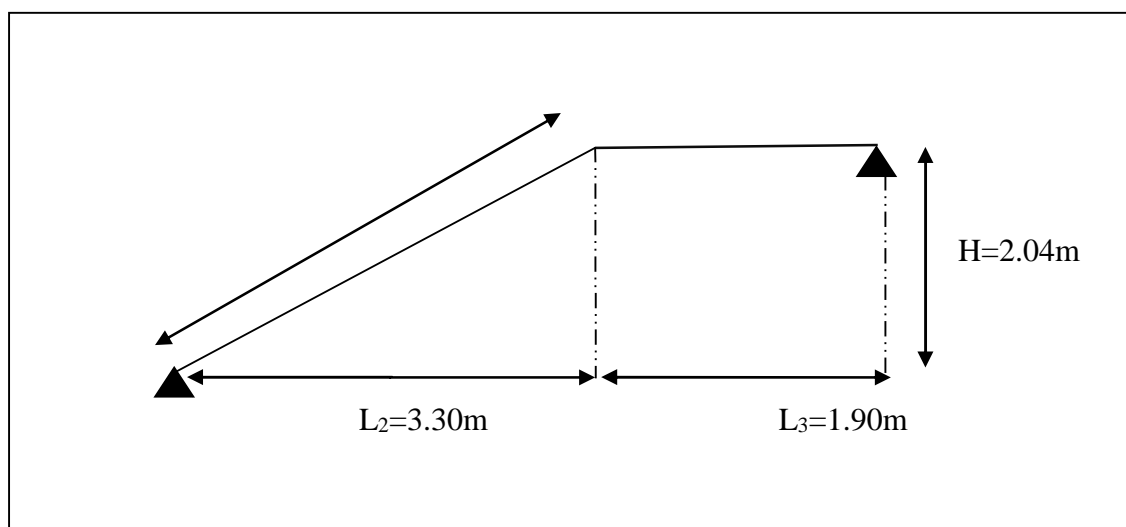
Schéma statique de l'escalier de SOUS-SOL et RDC
